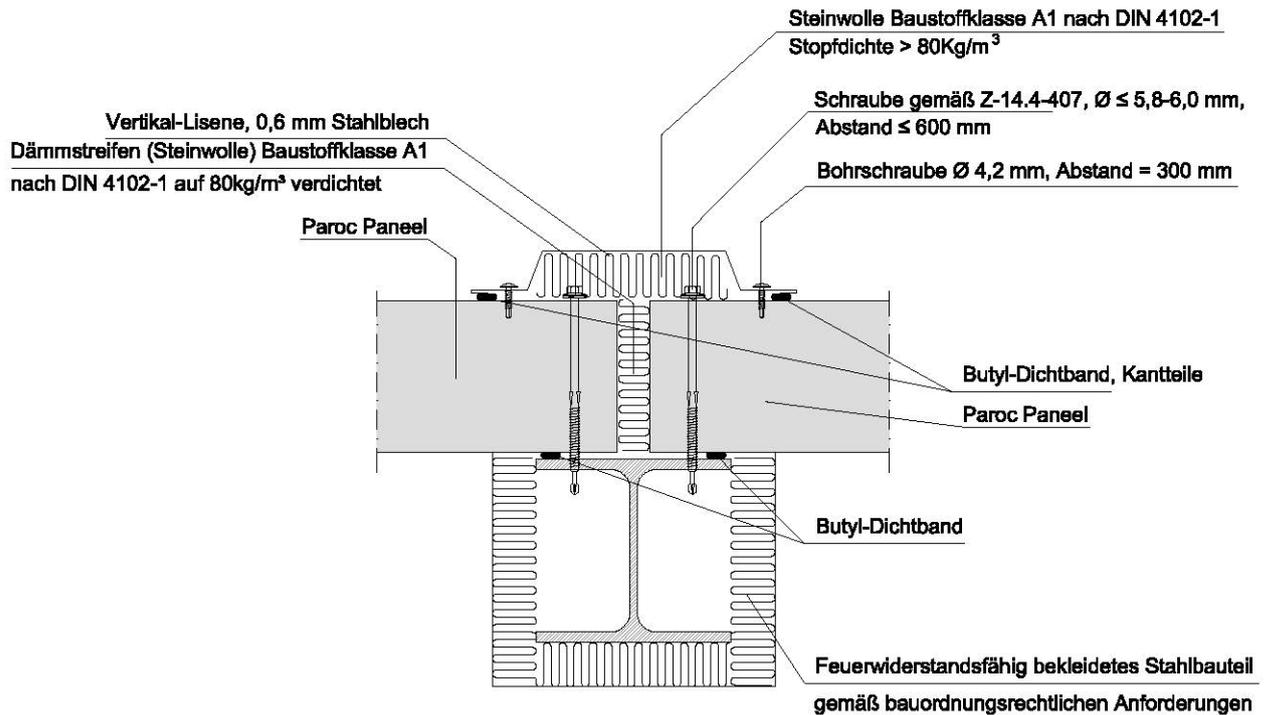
Detail kraftschlüssiger Anschluss an Stahlstütze
